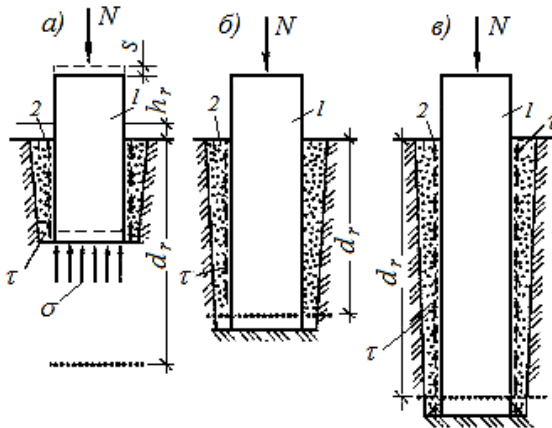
Характер впливу сил морозного здимання на фундамент: *a* – при розміщенні підшви фундаменту в межах глибини промерзання; *б* – при розміщенні підшви фундаменту опалювальної будівлі нижче глибини промерзання; *в* – те ж, неопалюваного будинку; *l* – фундамент; *2* – зворотне засипання; □ – нормальні напруження морозного здимання; □ – дотичні напруження морозного здимання; *N* – навантаження від будівлі;  $d_r$  – глибина промерзання;  $h_r$  – деформація морозного здимання ґрунту; *s* – величина переміщення фундаменту
